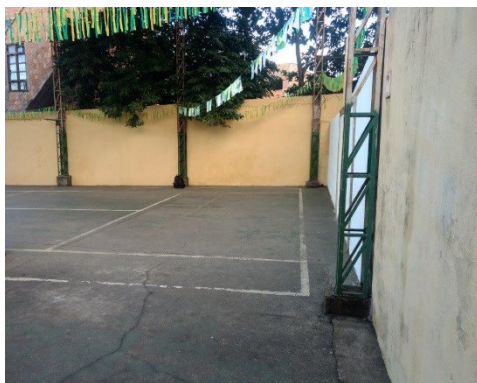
Detalhe do piso da quadra coberta em concreto desempenado
